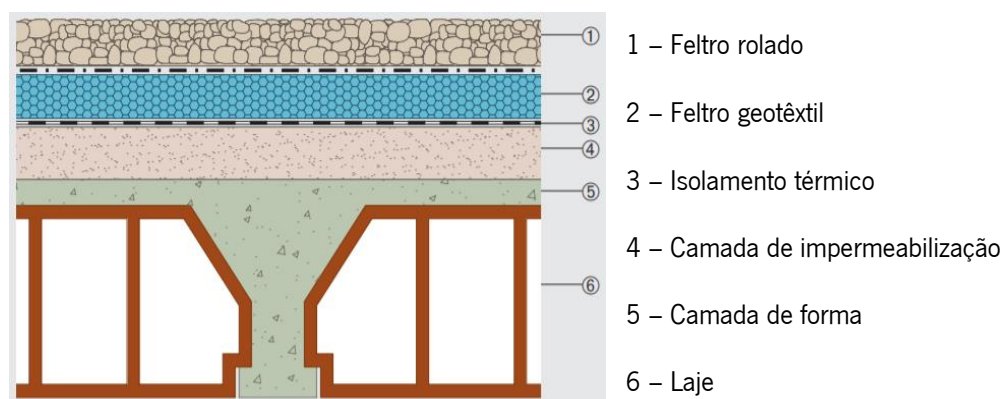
Pormenor construtivo tipo de uma cobertura plana invertida (adaptado de (DOW , n.d.))
